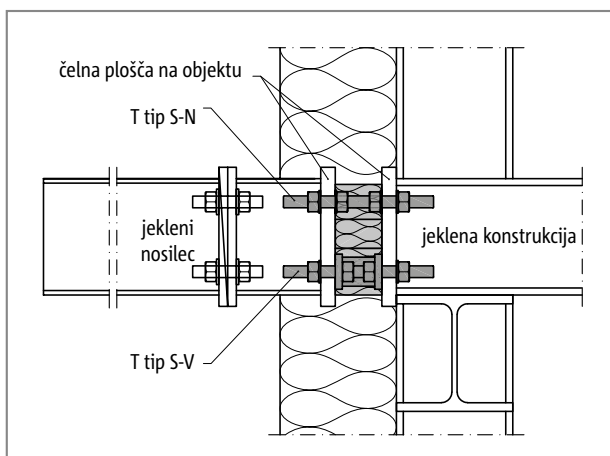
Schöck Isokorb® T tip S-V: podprta jeklena konstrukcija
